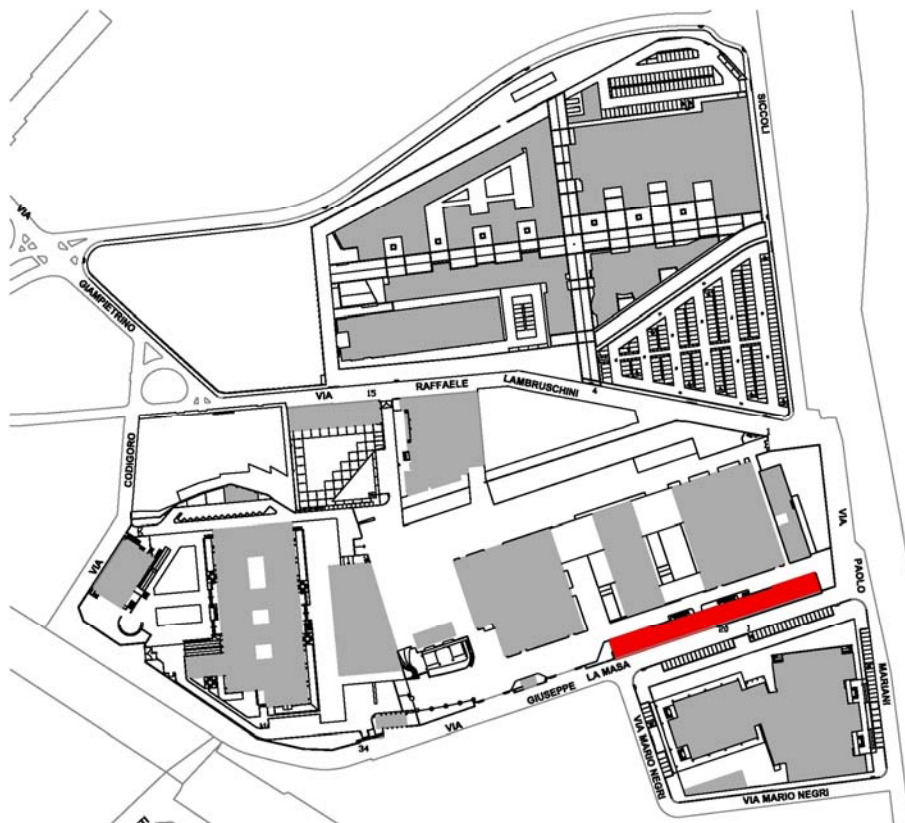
Planimetria Campus La Masa con evidenziazione Edificio 22
